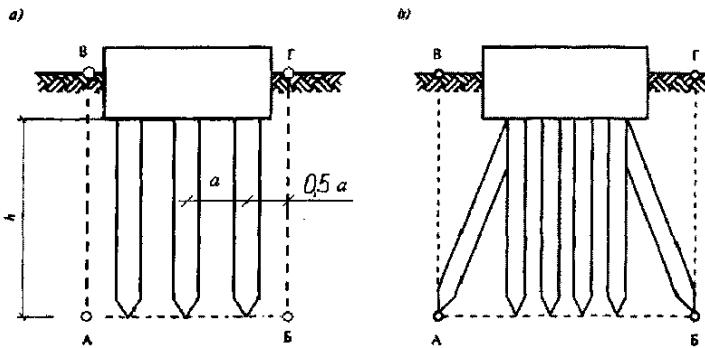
Определение границ условного фундамента при расчете осадки свайных фундаментов
